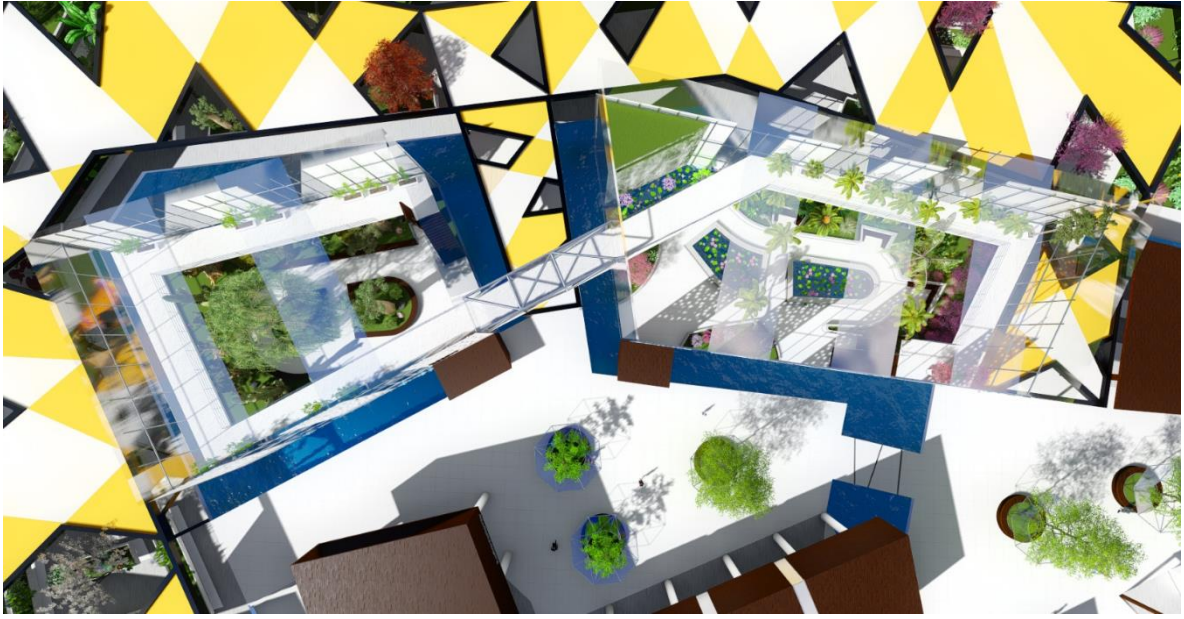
vista en planta de la conexión entre los dos invernaderos.
